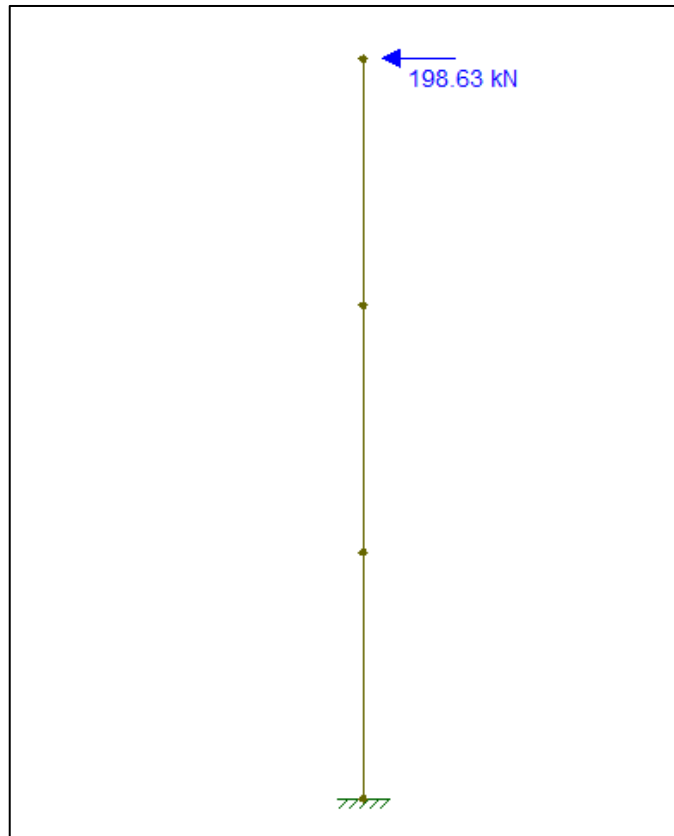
Empuxo localizado no topo do muro (Fonte: Próprio Autor)
